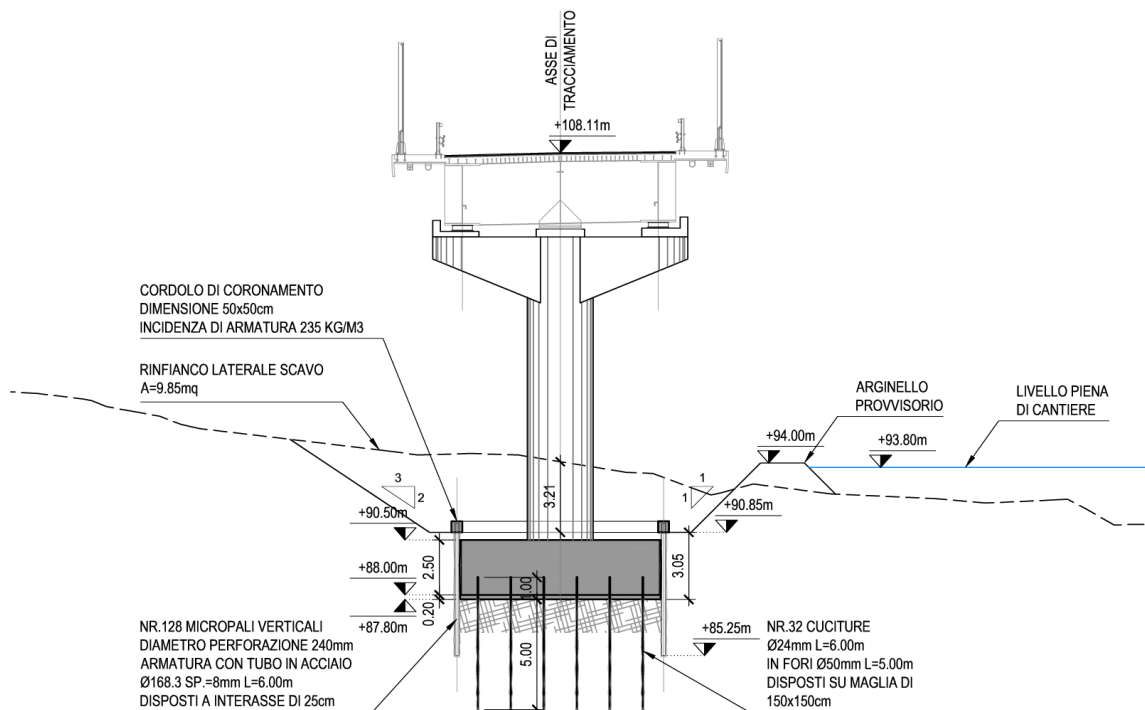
Sezione trasversale opera provvisoria pila 3.
